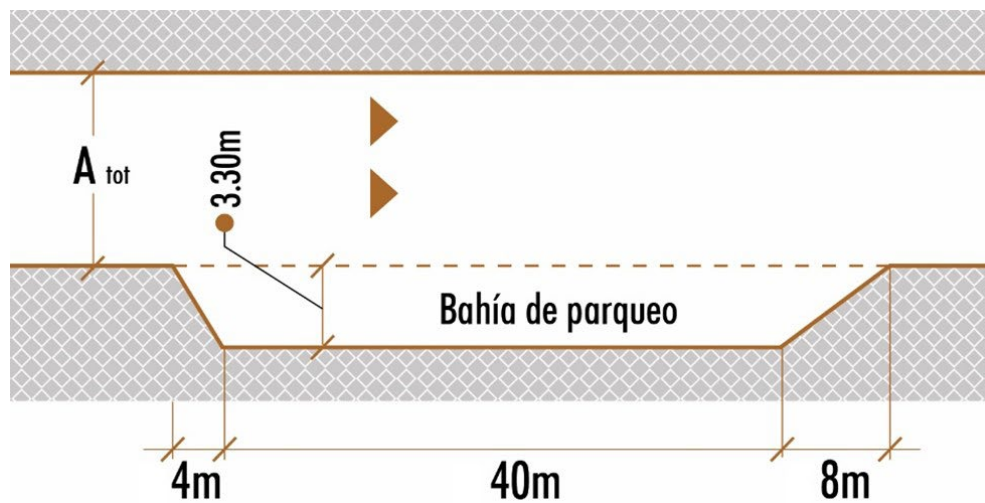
Bahía de parqueo túnel unidireccional (dimensiones en planta)
